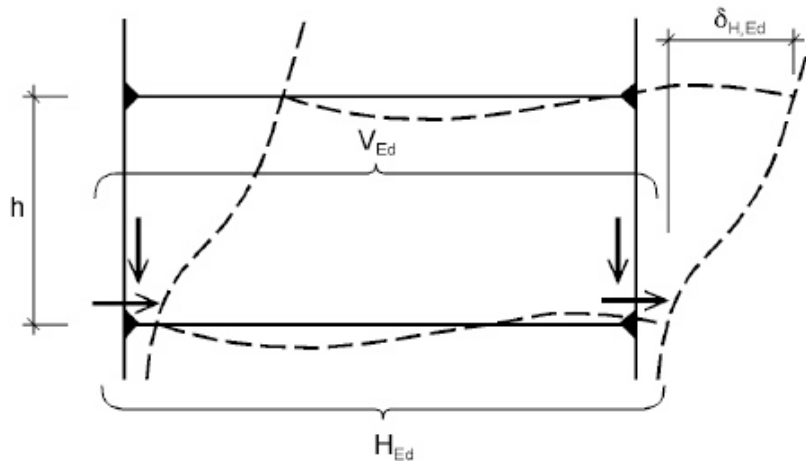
Notación para el apartado 5.2.1(4)
